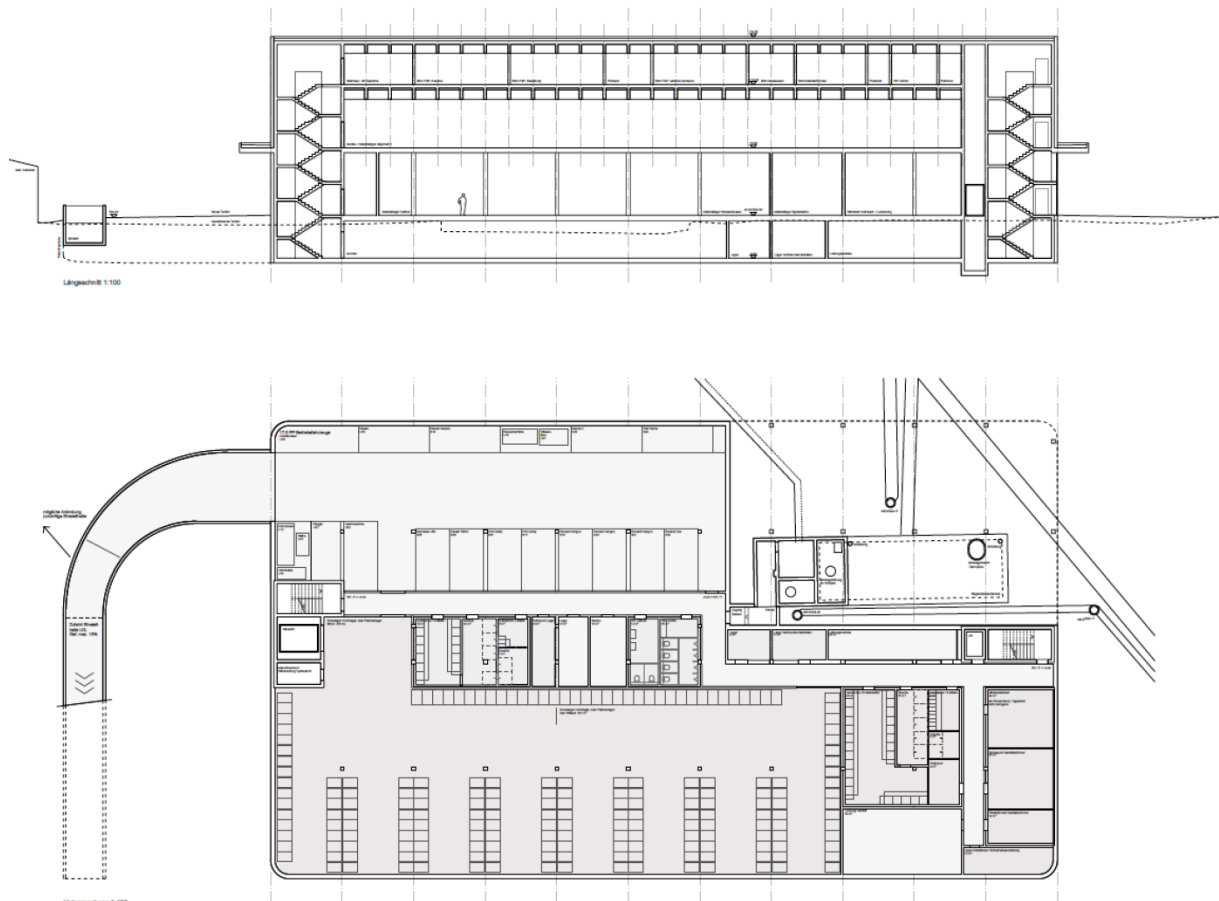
Grundriss Untergeschoss mit Längsschnitt (Quelle: Bietergemeinschaft 3 Steiner AG)
